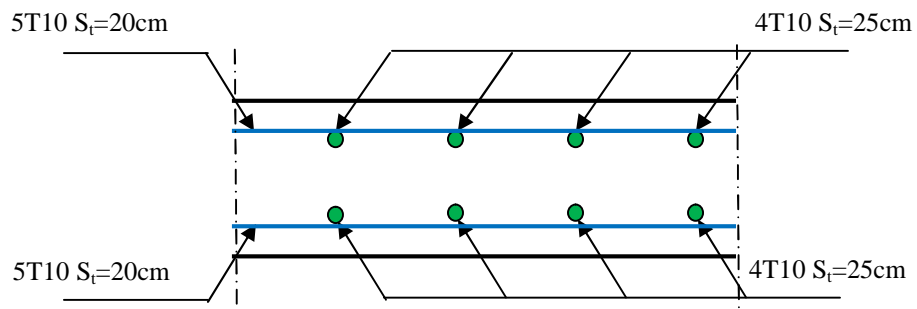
Vue en coupe du ferrailage de la dalle.
